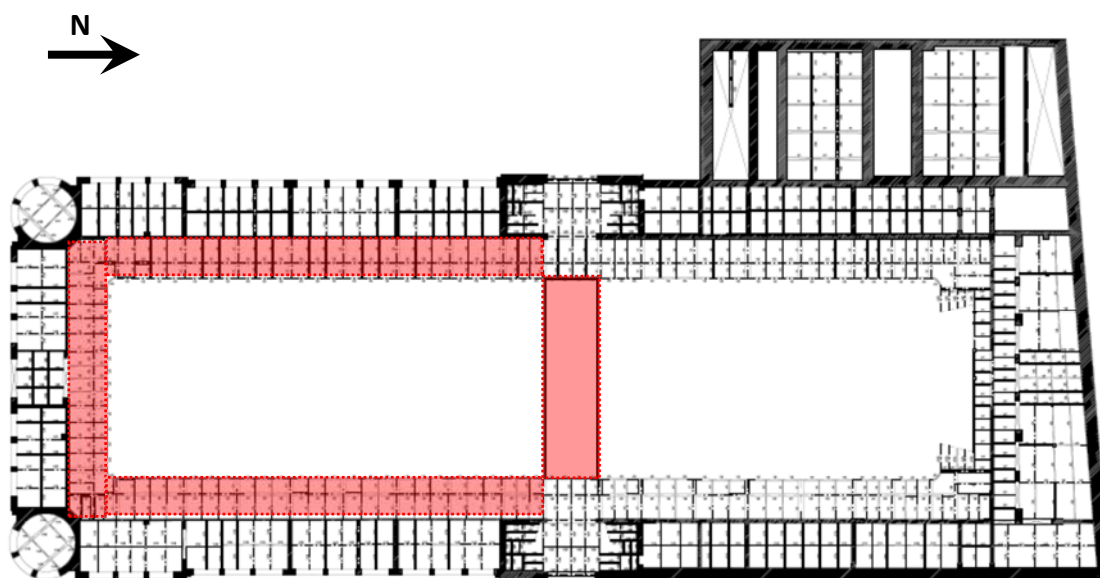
Planta do nível 1 com indicação a vermelho das zonas onde se verificam deformações estruturais dos elementos de betão armado.
